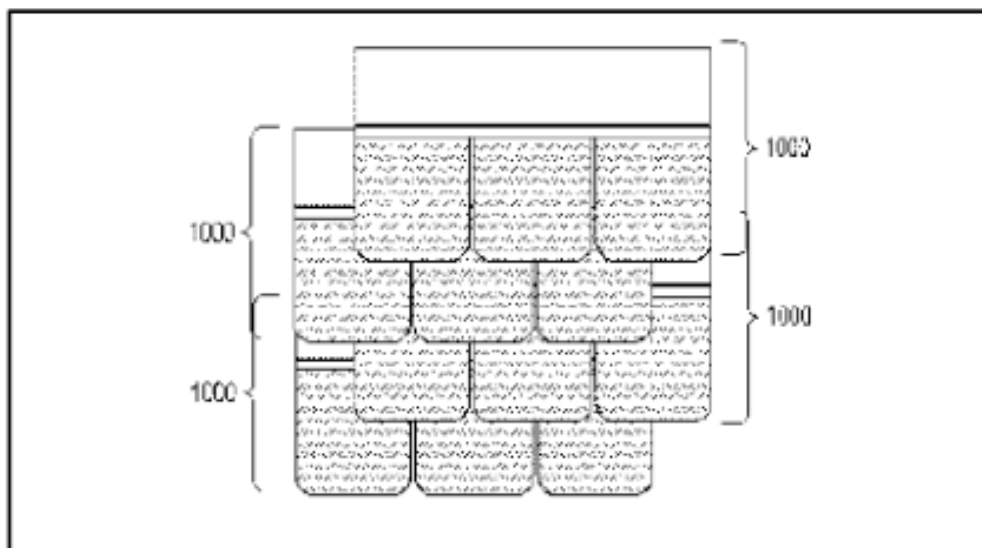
A telha ranhurada tipo *Shingle* e arranjo
